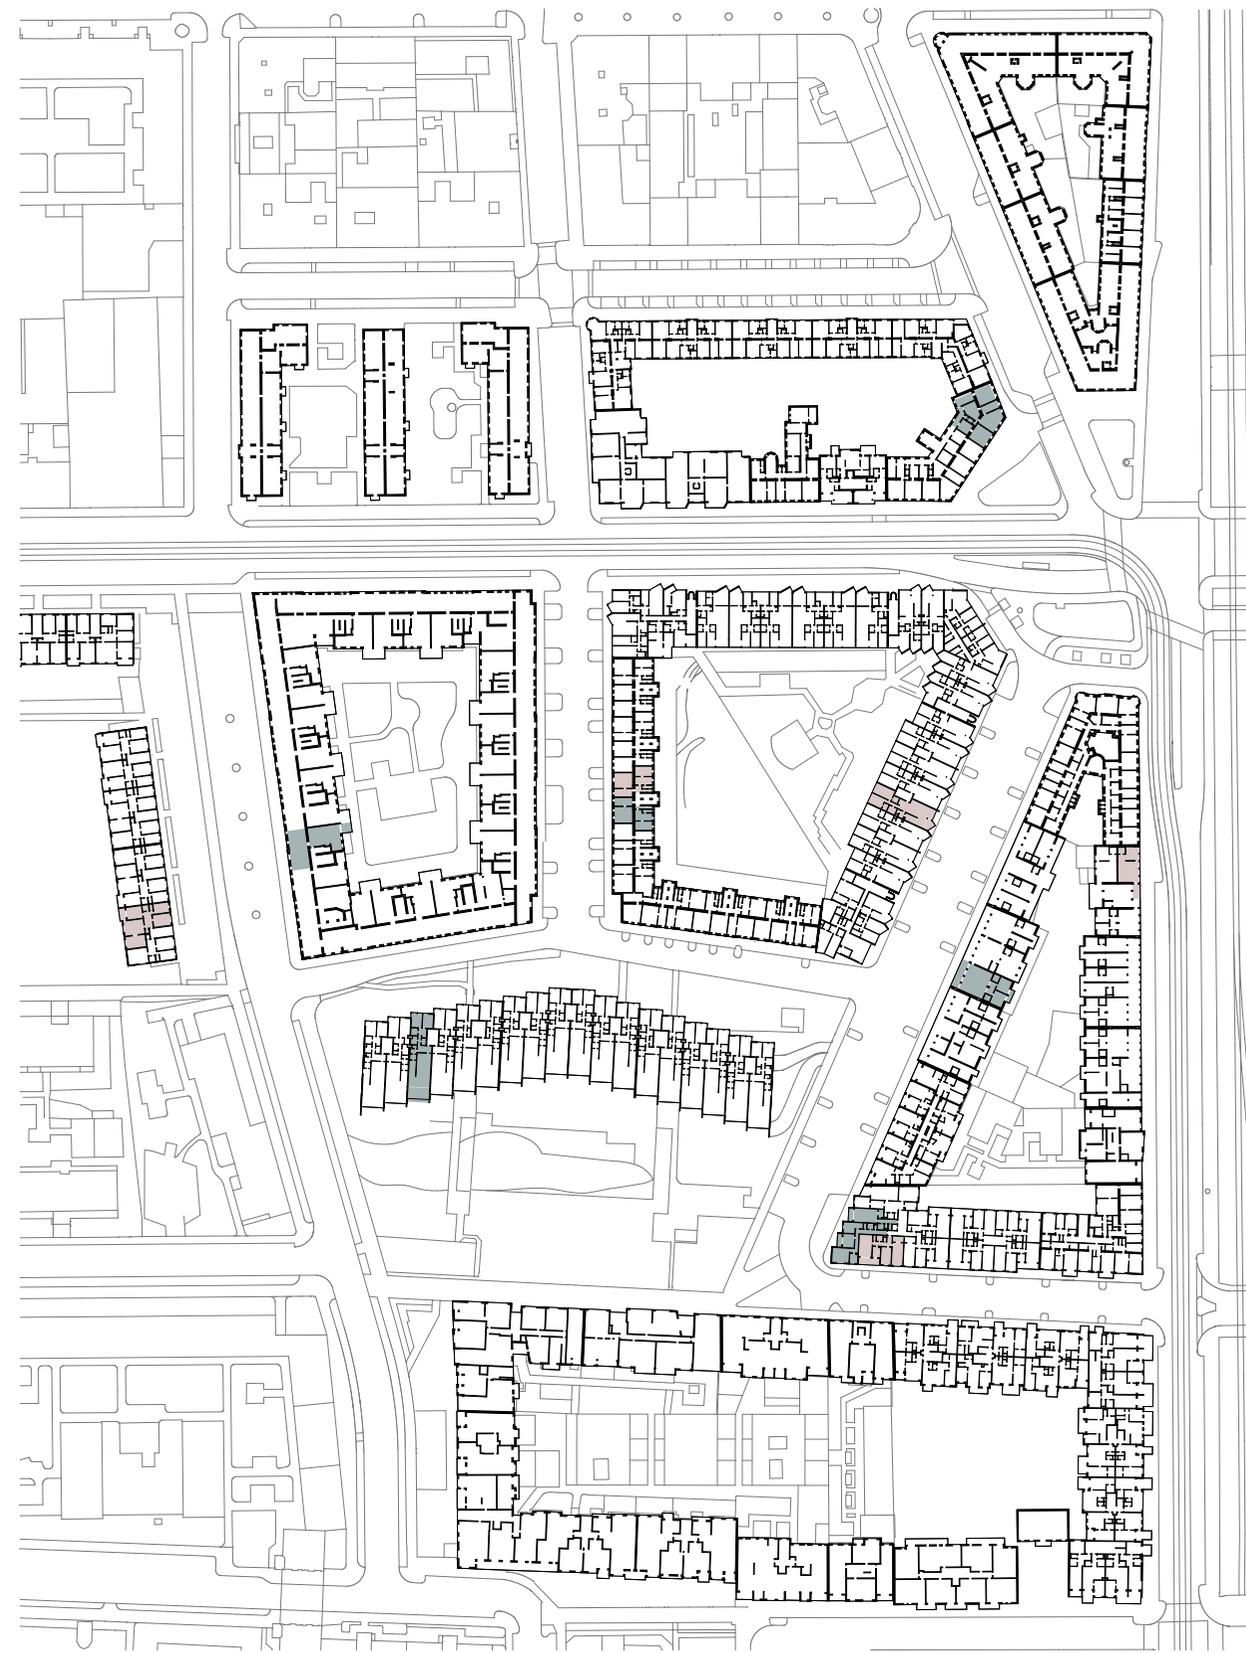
Lageplan lebendige Wirklichkeiten, 1:2000
